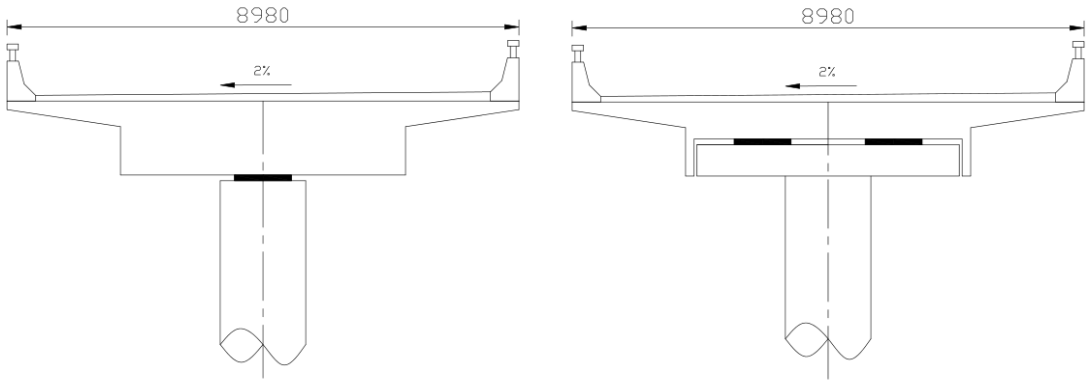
琵琶王立交桥辅道桥-梁端截面图（单位：mm）
